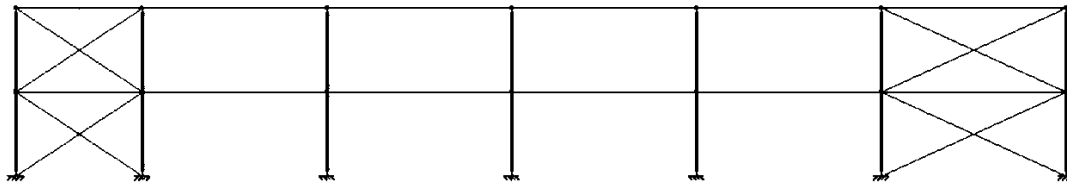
Plano perpendicular al pórtico de fachada. Fuente: CYPE 3D.
